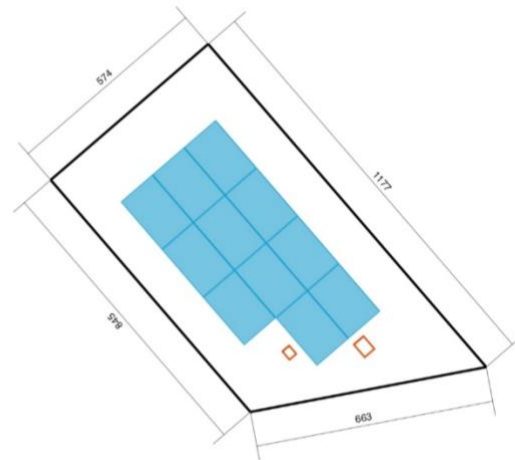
Egg 5, Belegungsplan, Dachfläche 2
